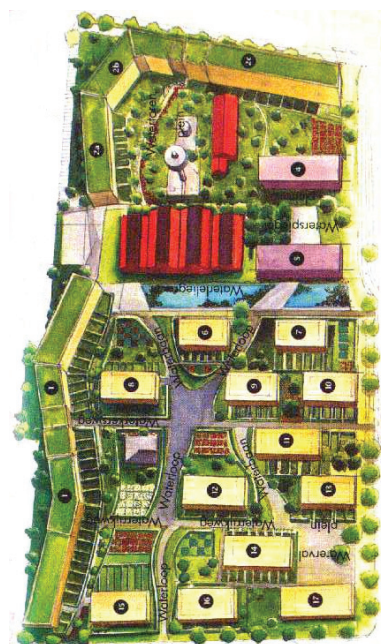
; Planta de conjunto do GWL Terrein, Amesterdão.
